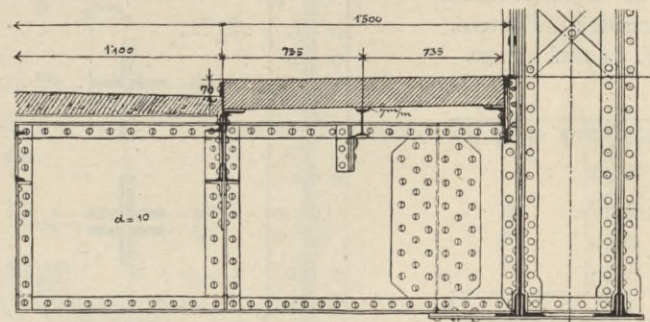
Untergurtausbildung der St. Lorenzo-Brücke über die Etsch in Trient. St. W. 89,70 m. Mstb. 1 : 40.
